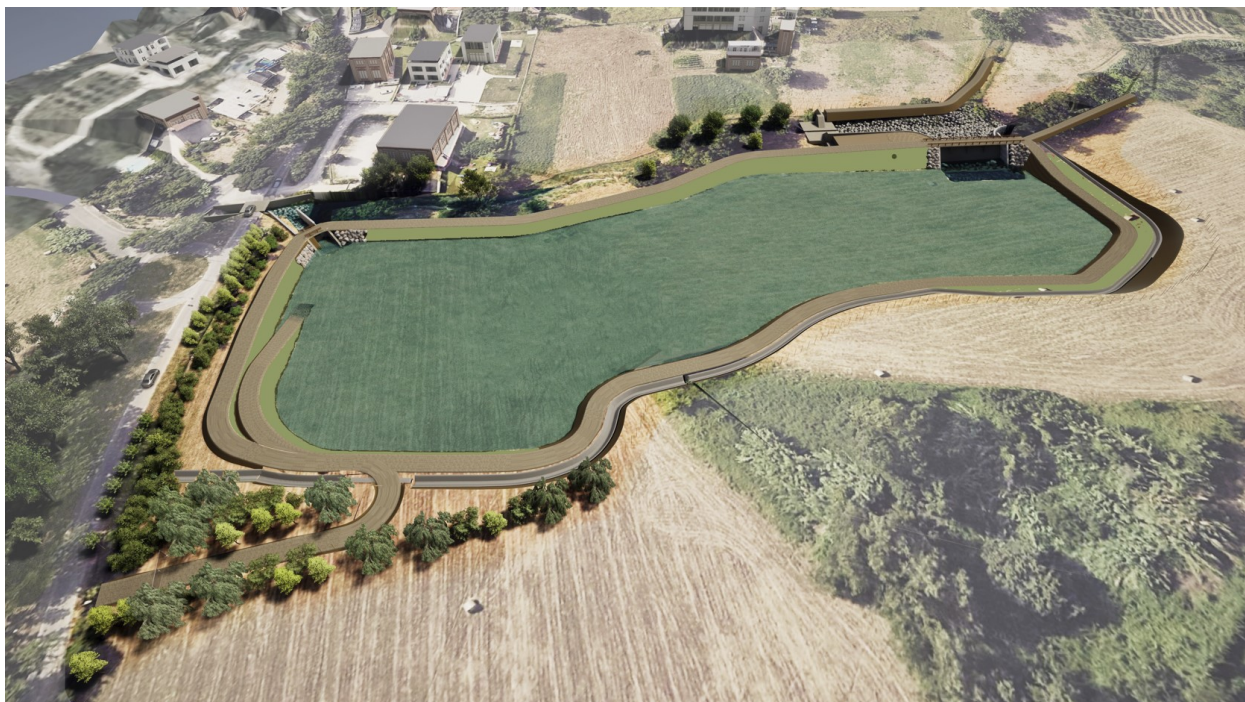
Vista planivolumetrica dell'intera opera: vasca di laminazione con ipotesi di piena
